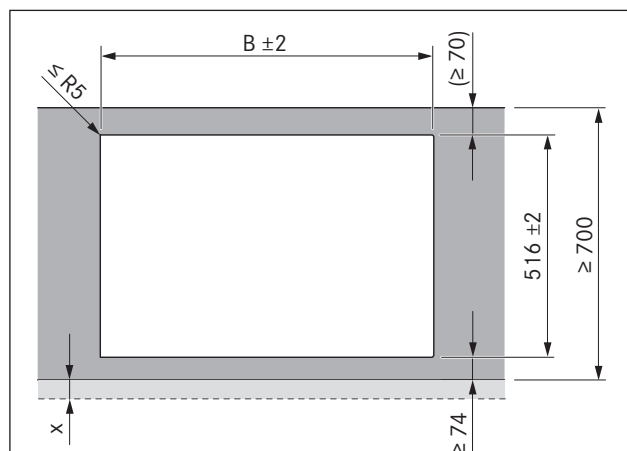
Medidas de recorte, montagem por sobreposição
